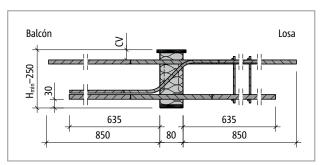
Schöck Isokorb® T tipo K-M13 hasta M14: Sección del producto
